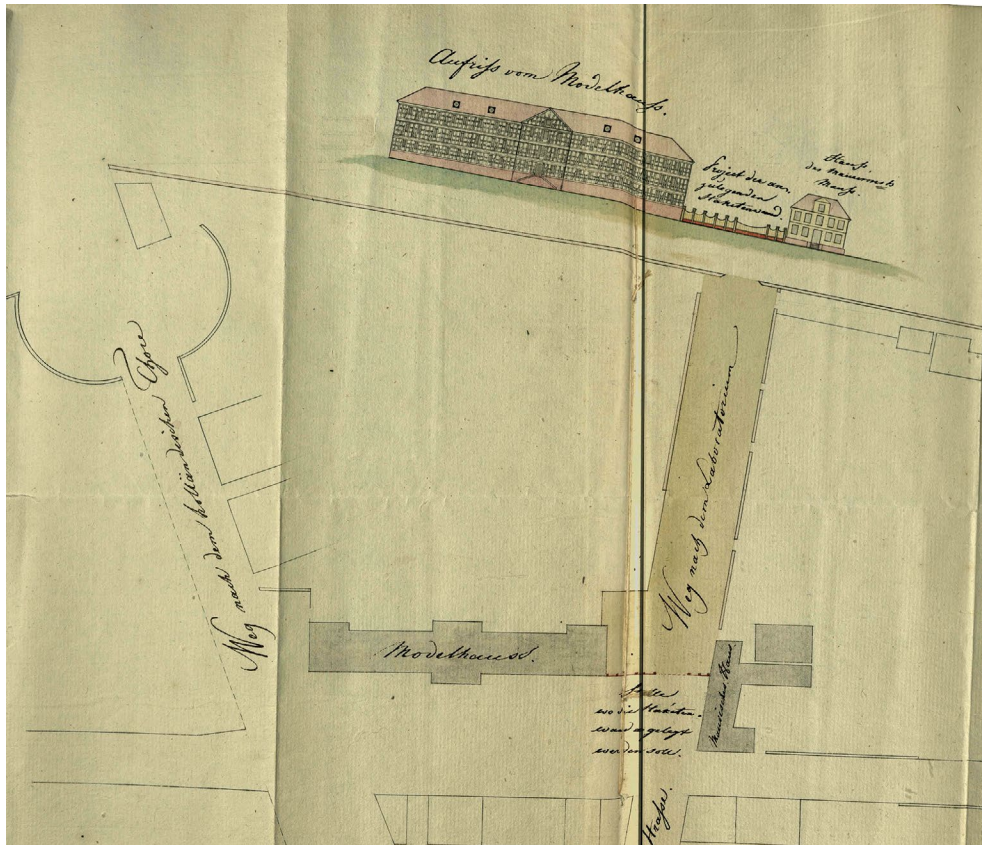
Anonymus, Lageplan, 1822. Die Zeichnung (Ausschnitt) zeigt das Areal zwischen Modellhaus, Holländischem Tor und Zollmauer. Interessanterweise wird das Modellhaus auch im Aufriss als unverputzter Fachwerkbau gezeigt.
